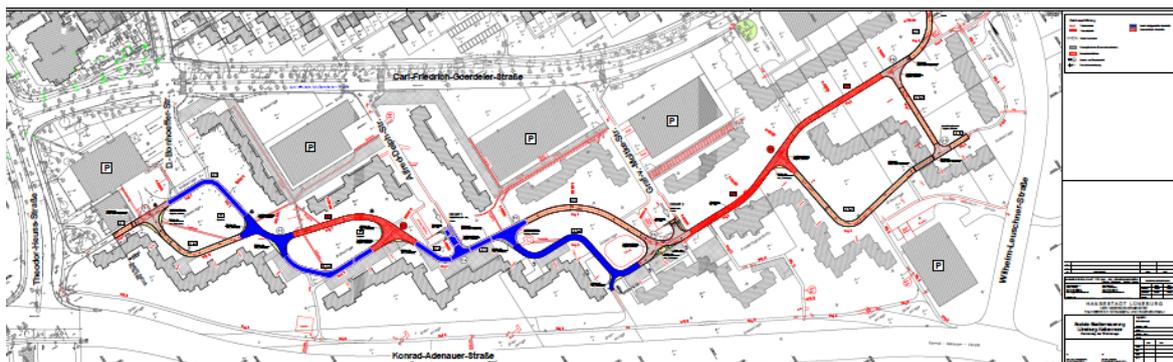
Sanierung der Wohnwege, geplante Fertigstellung
